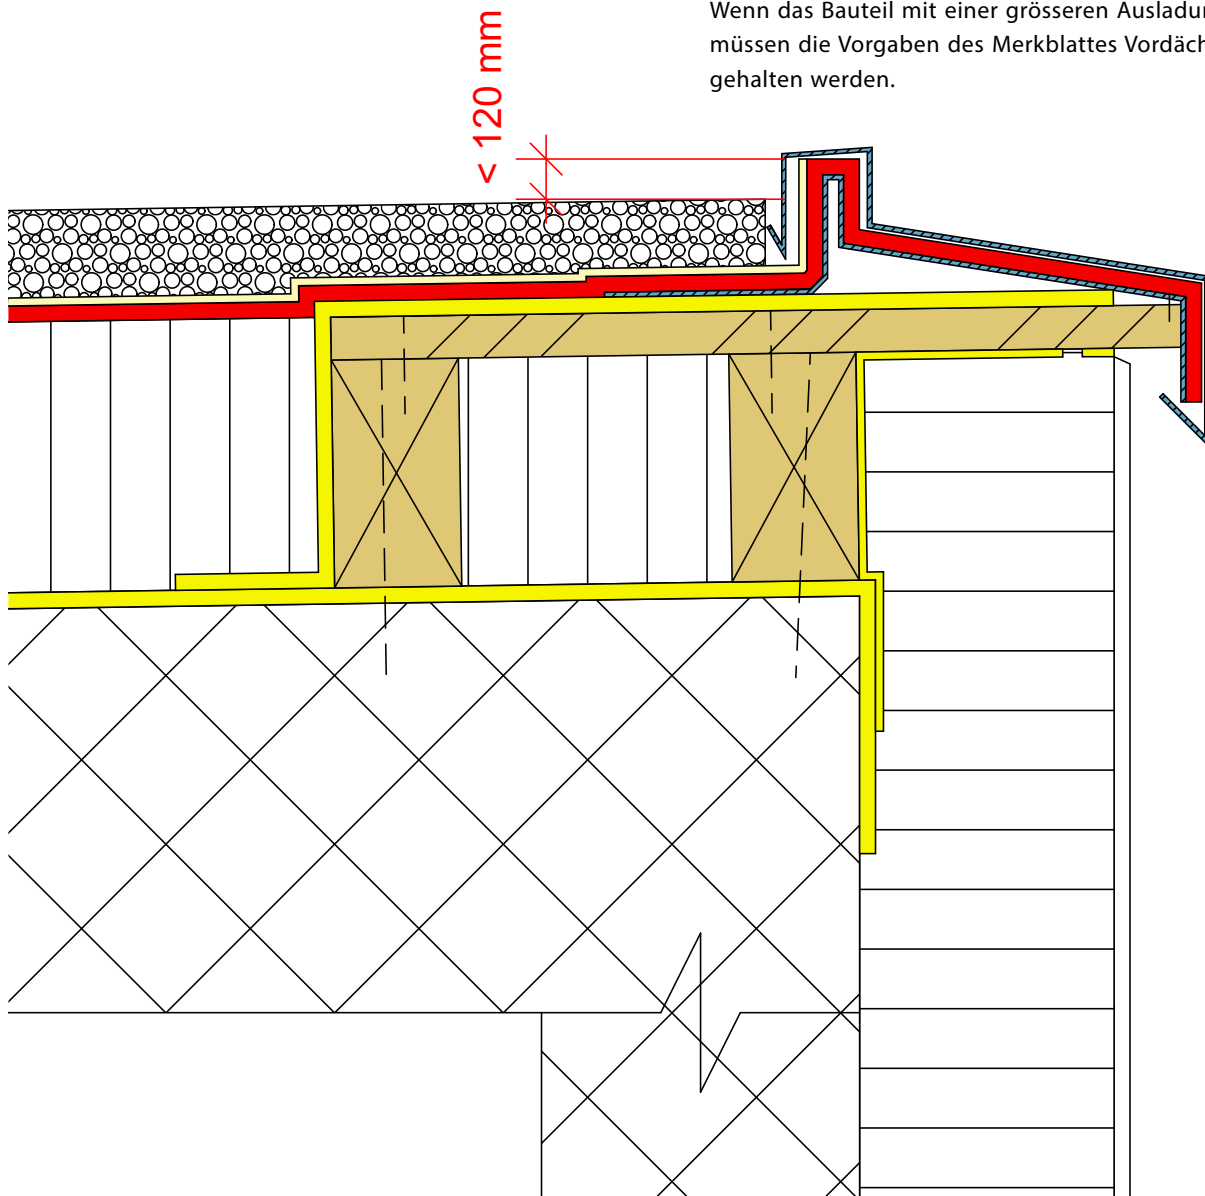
Überlaufsichere Dachrandkonstruktionen
